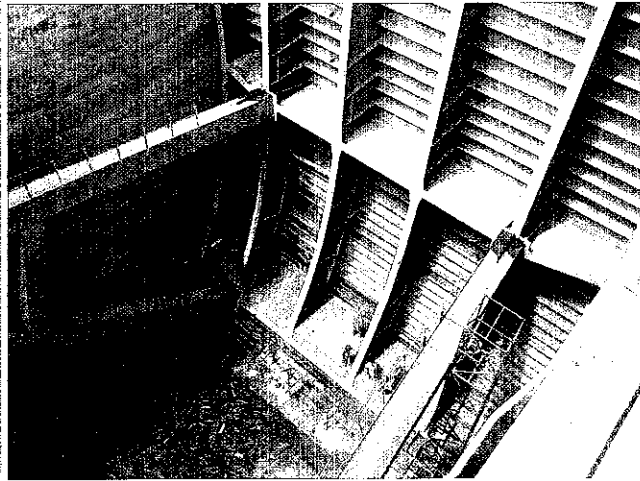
Estrutura metálica instalada no Vão do Vertedouro 15.
